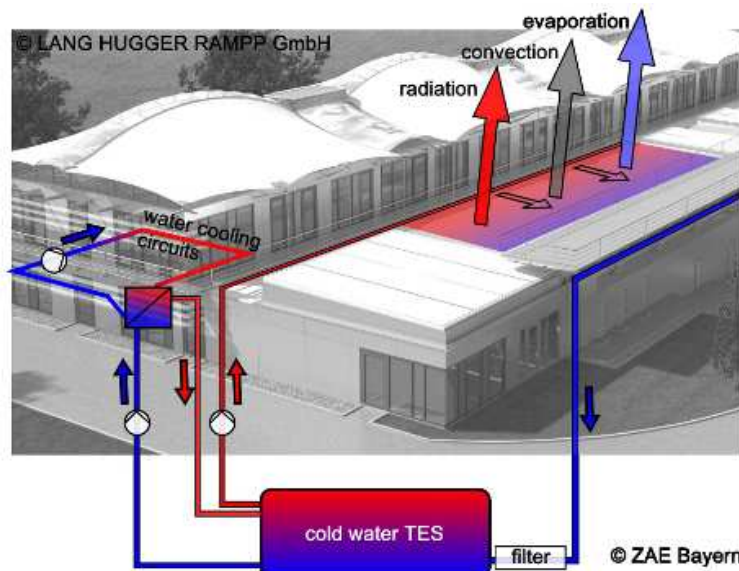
Schéma de l'installation du système de rafraîchissement sur le bâtiment de Würzburg [LRE14]
